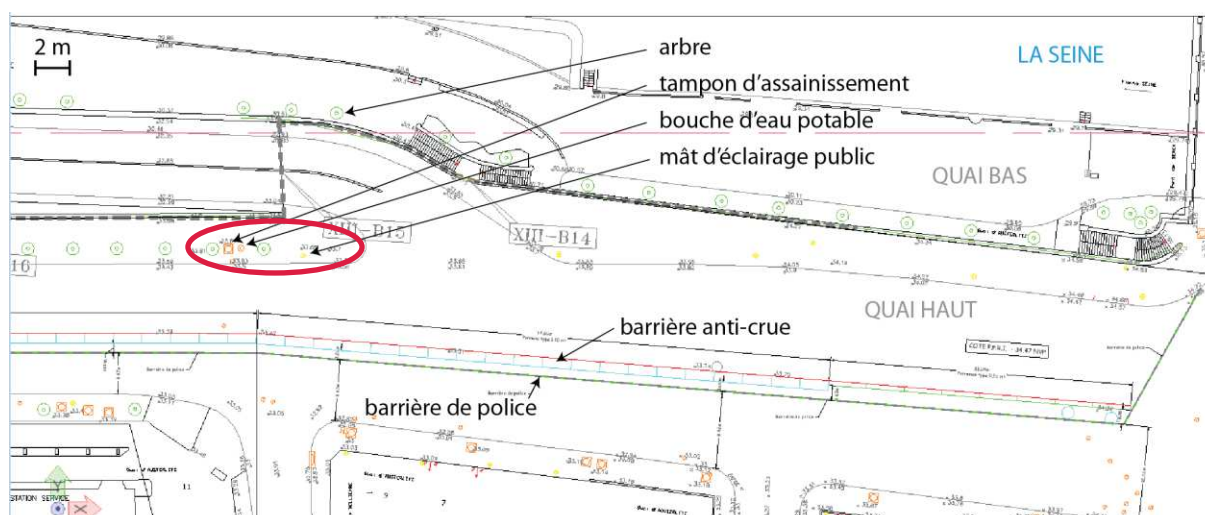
Extrait du plan d'implantation de la barrière anticrue quai d'Austerlitz (source : fond de plan de la DVD)
